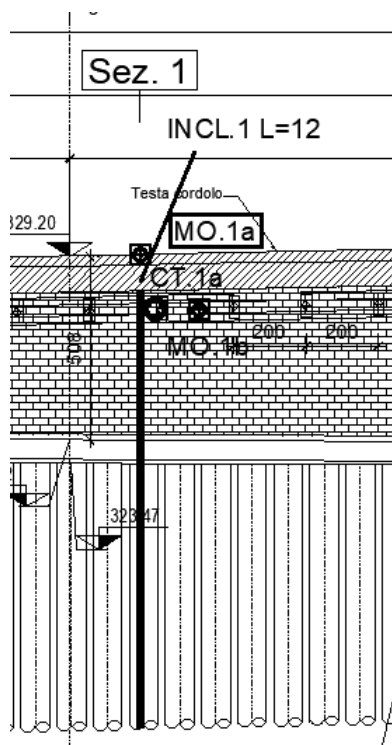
Strumentazione tipo sezione di monitoraggio.
